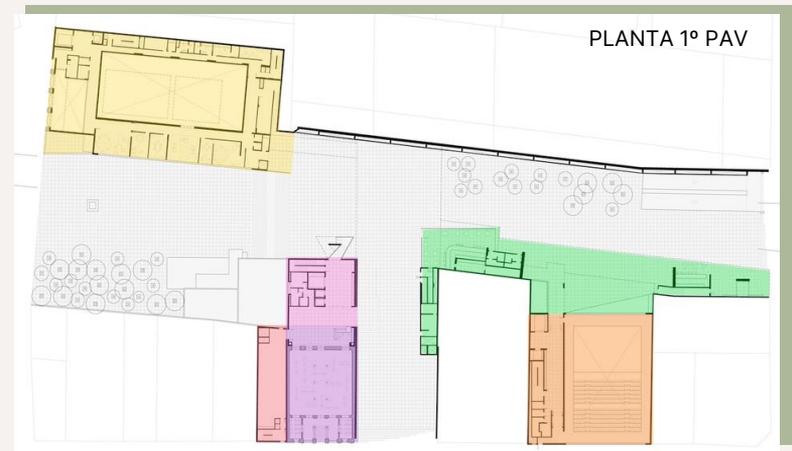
PLANTA 1ºPAV. DA PRAÇA DAS ARTES
